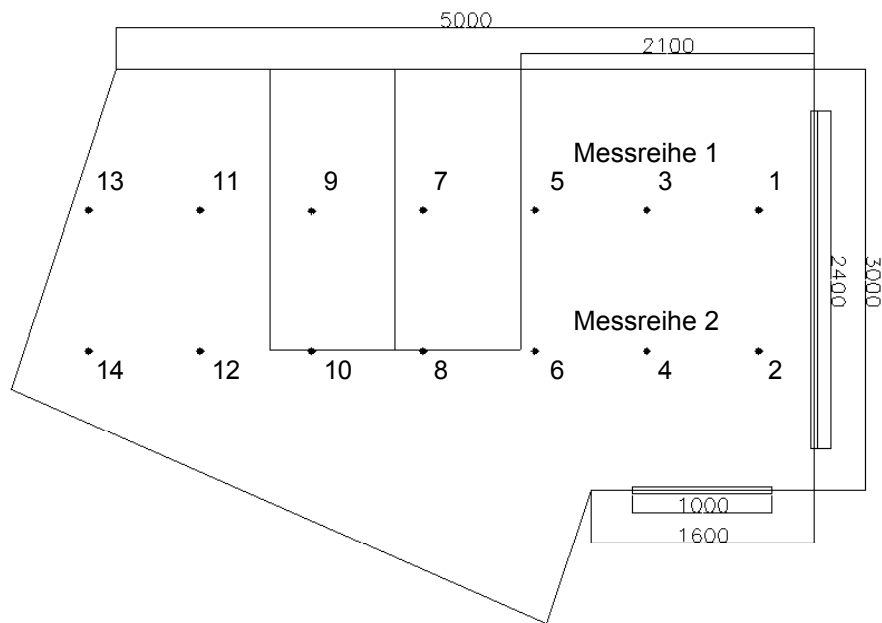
Schematischer Grundriss des Büros B 104 im 1. OG des Südflügels. Die beiden Messreihen (Messpositionen 1 bis 14) sind markiert. Alle Abmessungen sind in mm angegeben.
